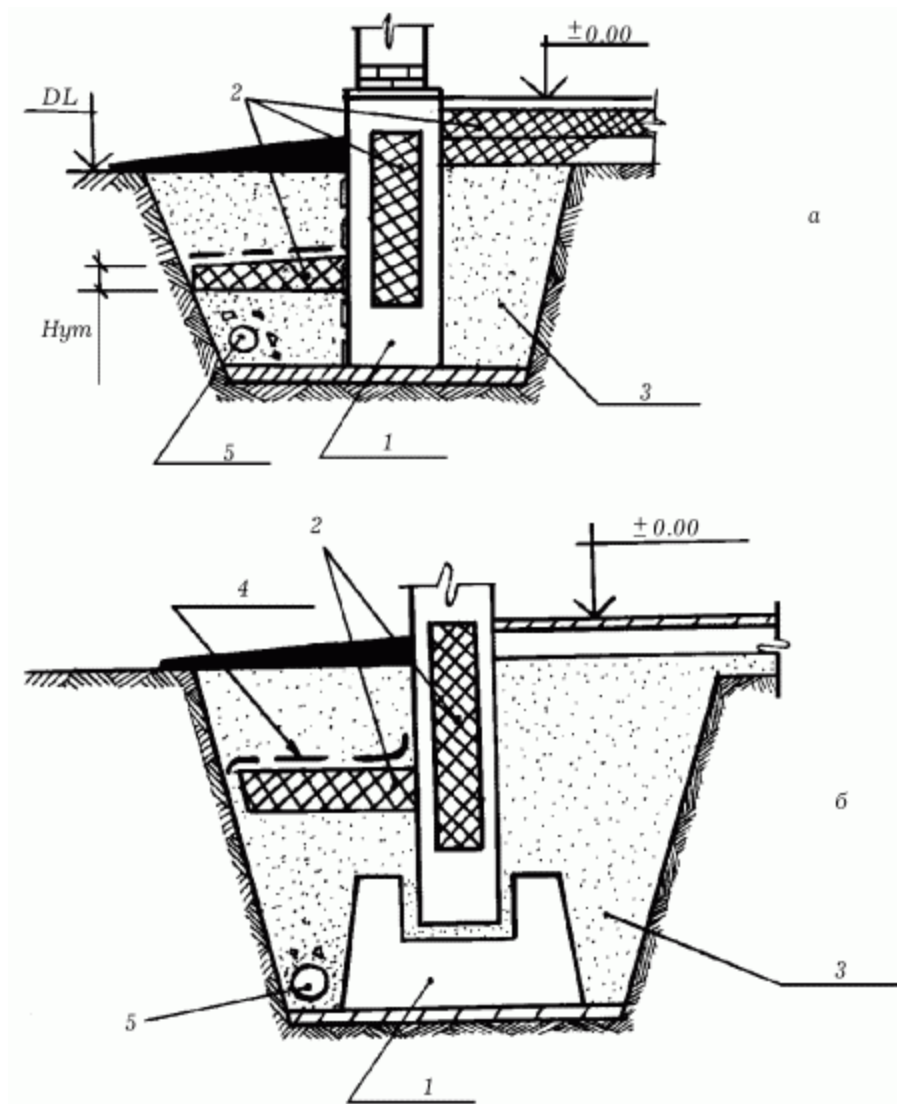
Устройство теплоизоляции в малозаглубленных фундаментах: а – ленточный фундамент; б – столбчатый фундамент; 1 – цемент; 2 – теплоизоляция; 3 – песчаная подушка; 4 – гидроизоляция; 5 – дренаж.
